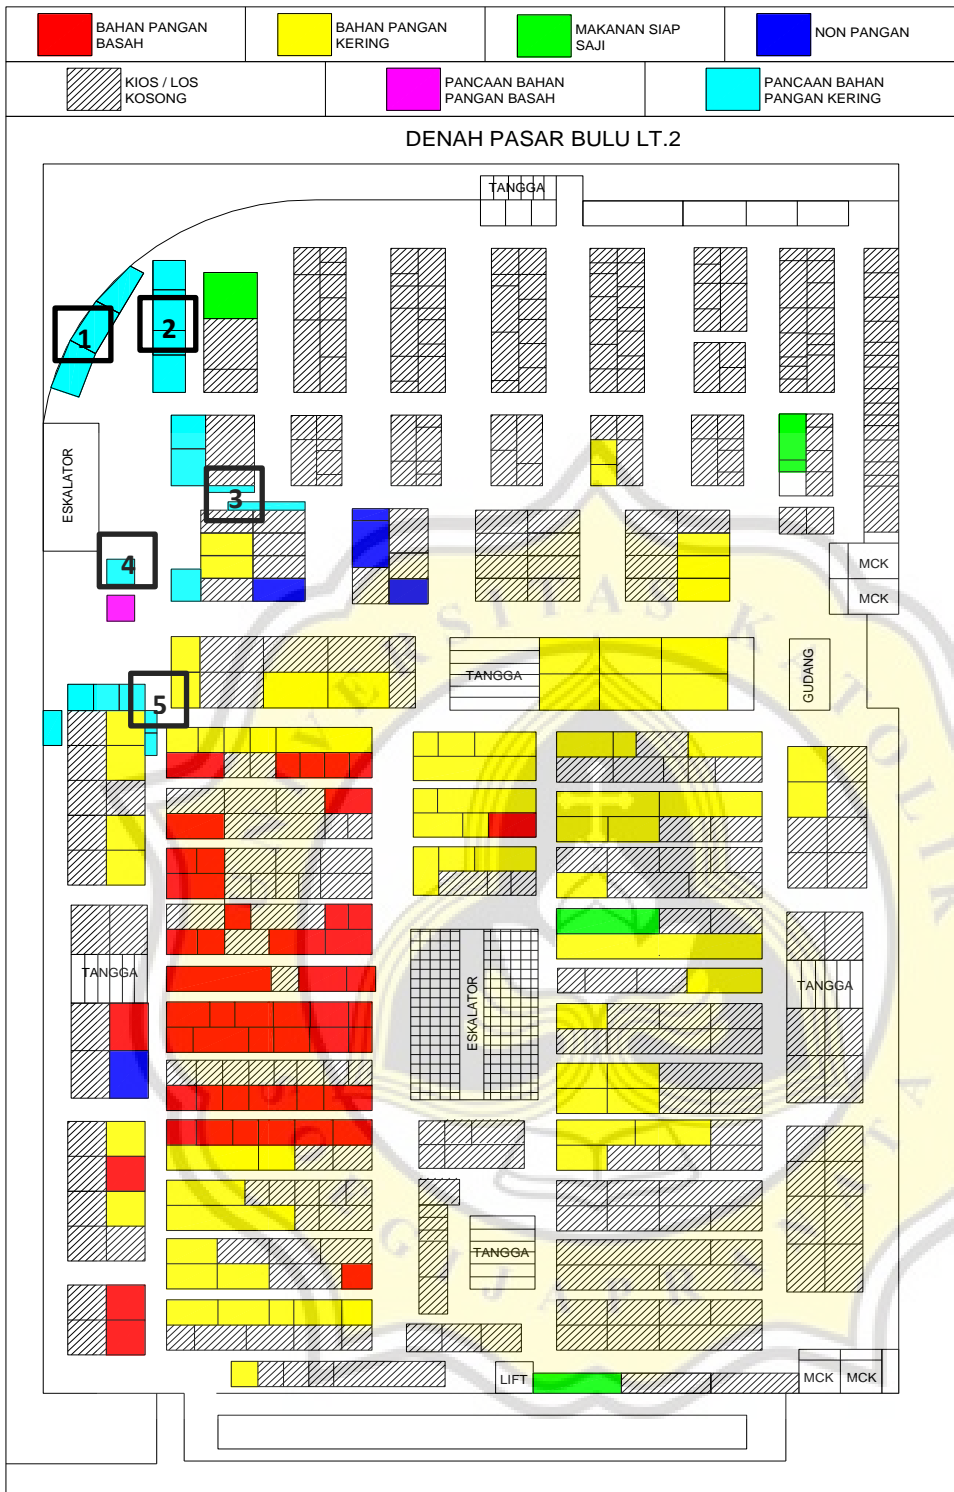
Denah Bangunan Persebaran Komoditas Pedagang pada Pasar Bulu Lantai 2
